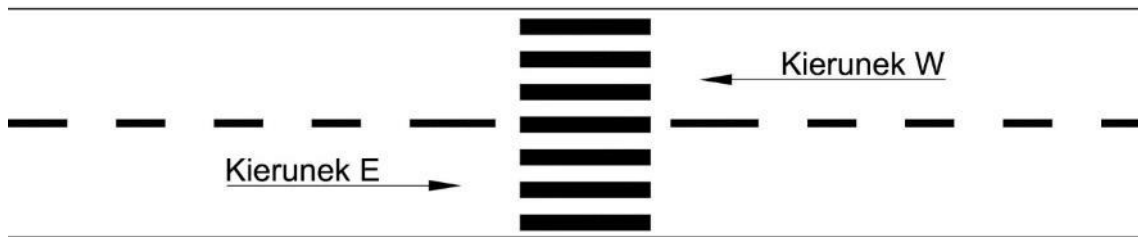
Elementy przekroju poprzecznego – przykład VI.
